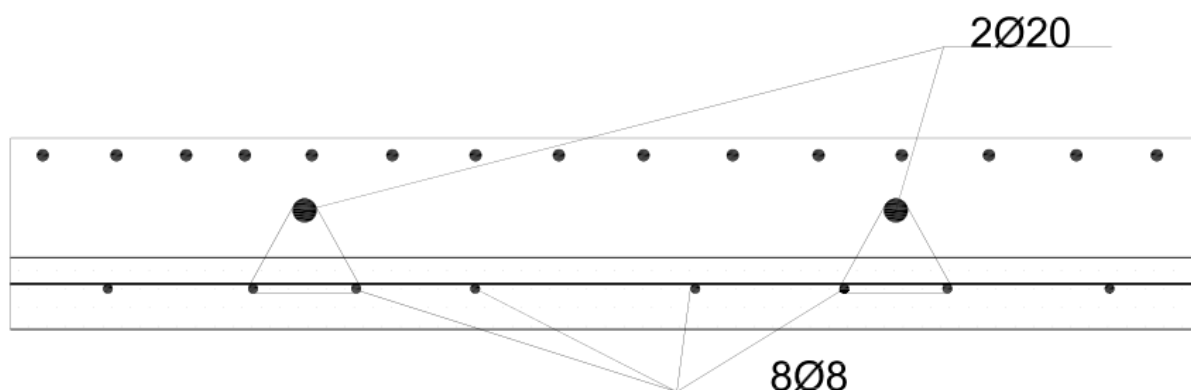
Solução final da pré-laje só com armadura para fase de construção (corte longitudinal)
